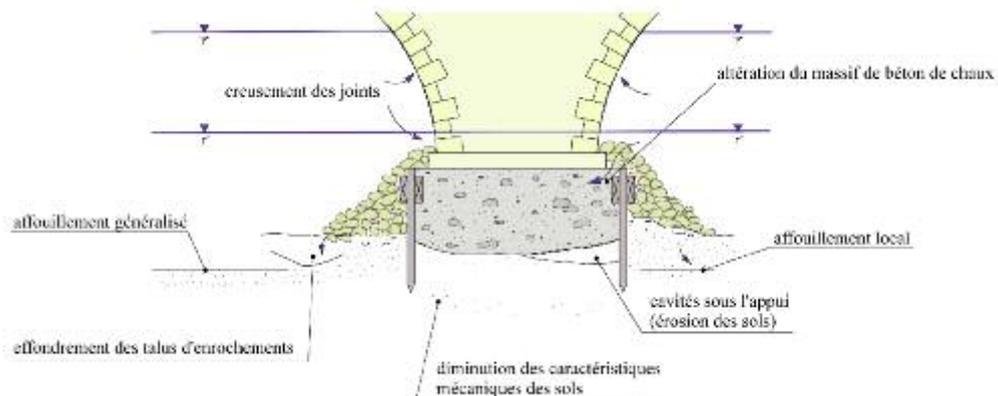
dégradations type sur un massif de fondation superficielle
